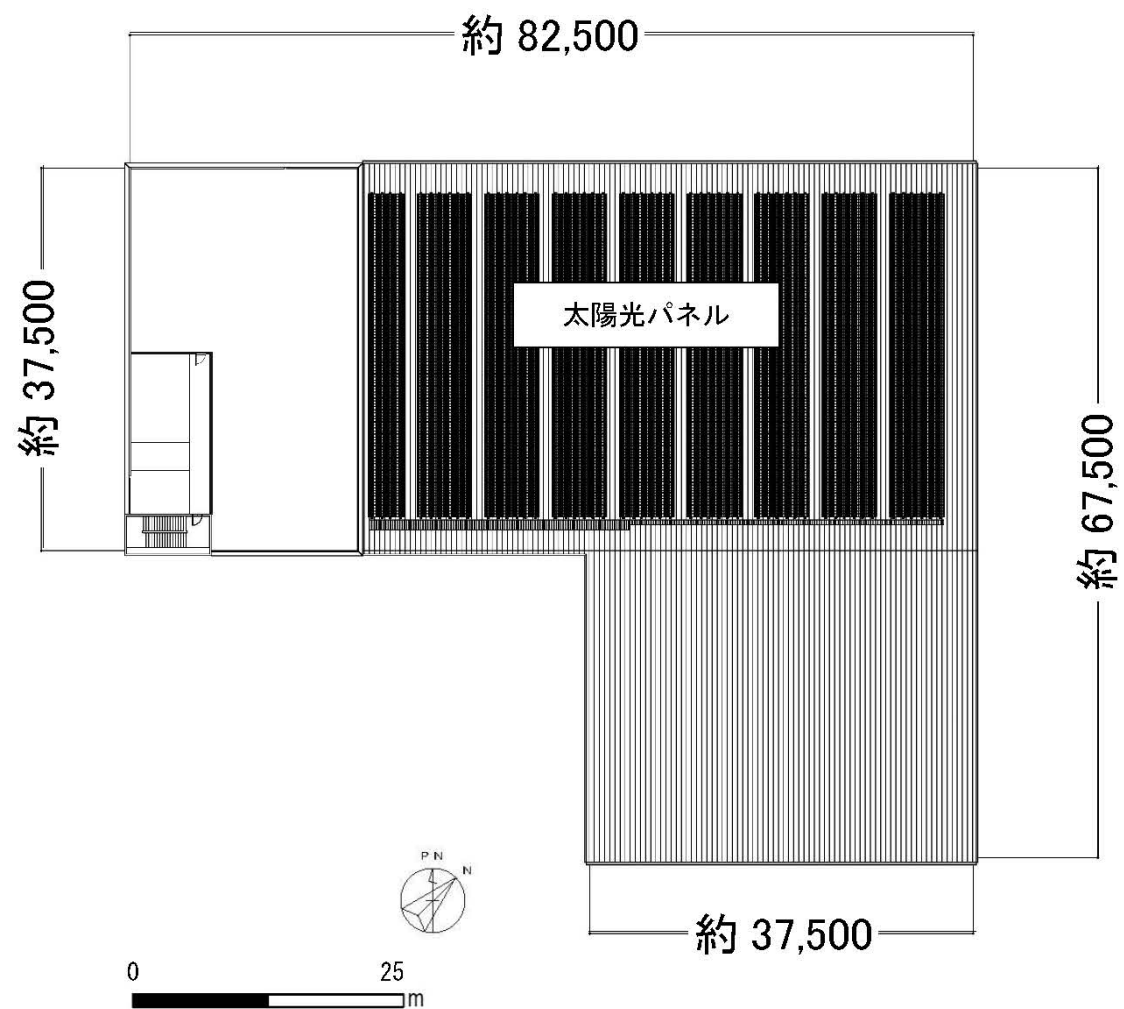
(5) 計画建物平面図 (5 階・屋上) : 単位 mm
